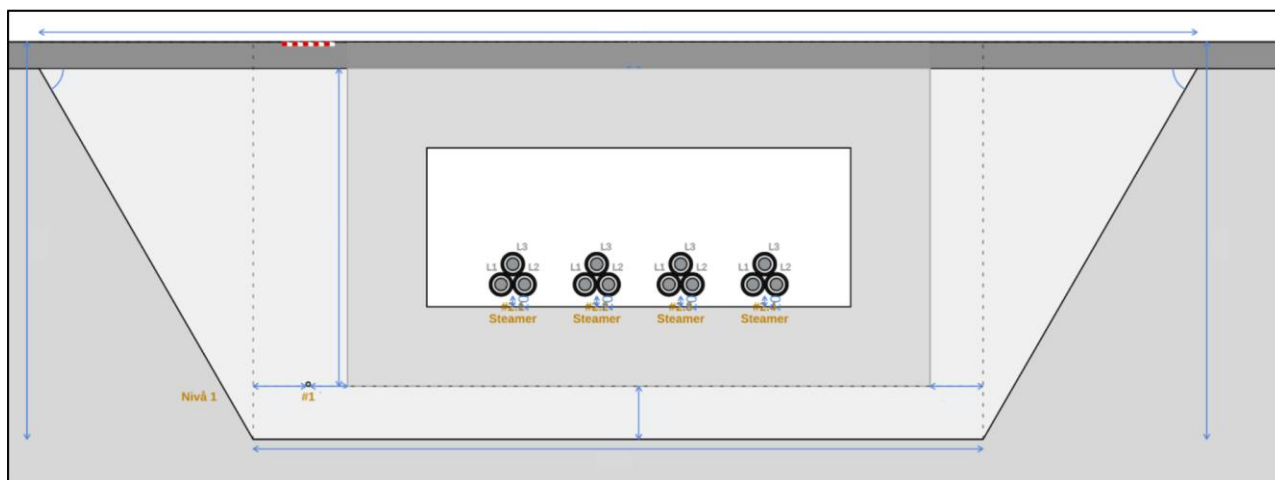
Prinsippkisse for 11 kV kabler i betong kulvert/kanal under bakkenivå.
